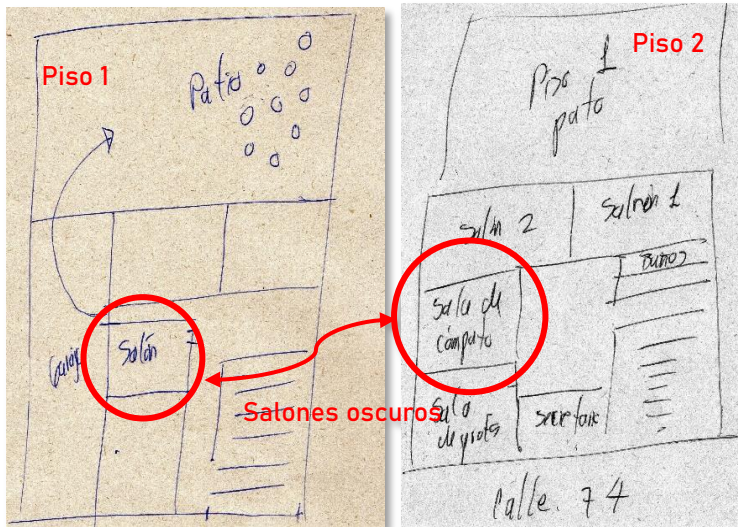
, plano primera y segunda planta instalación 74, egresado DR
